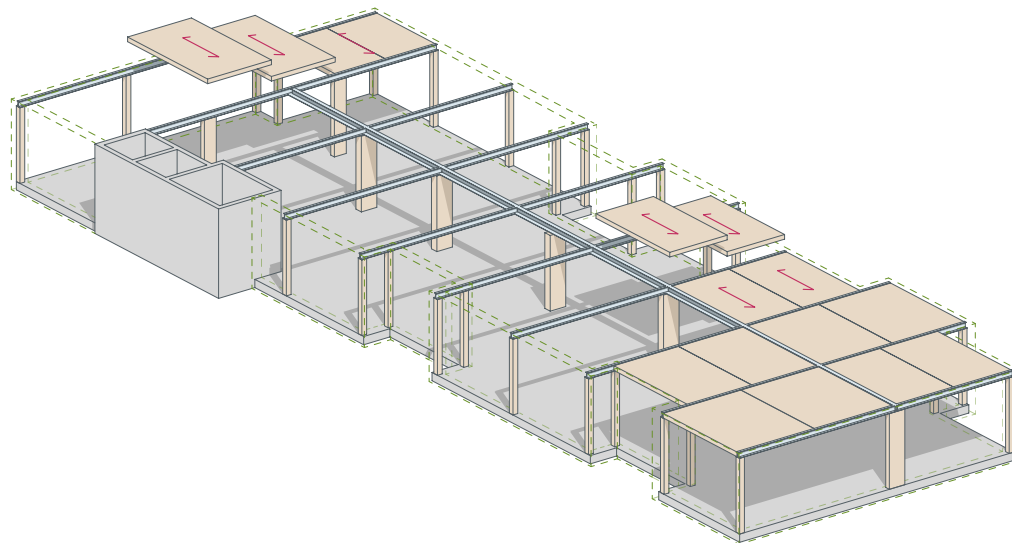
Tragwerk laut Ausschreibung - Regelgeschoss (Grundriss)
